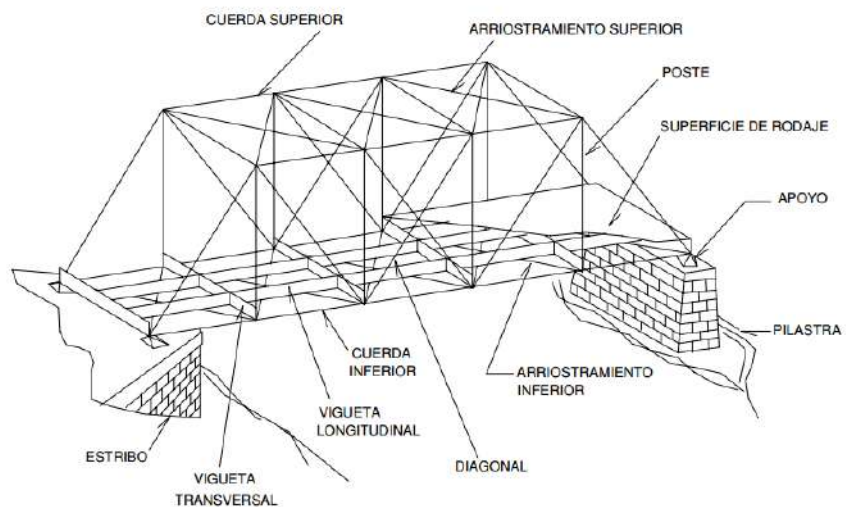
Partes de Puente reticulado metálico de Tablero Inferior.
